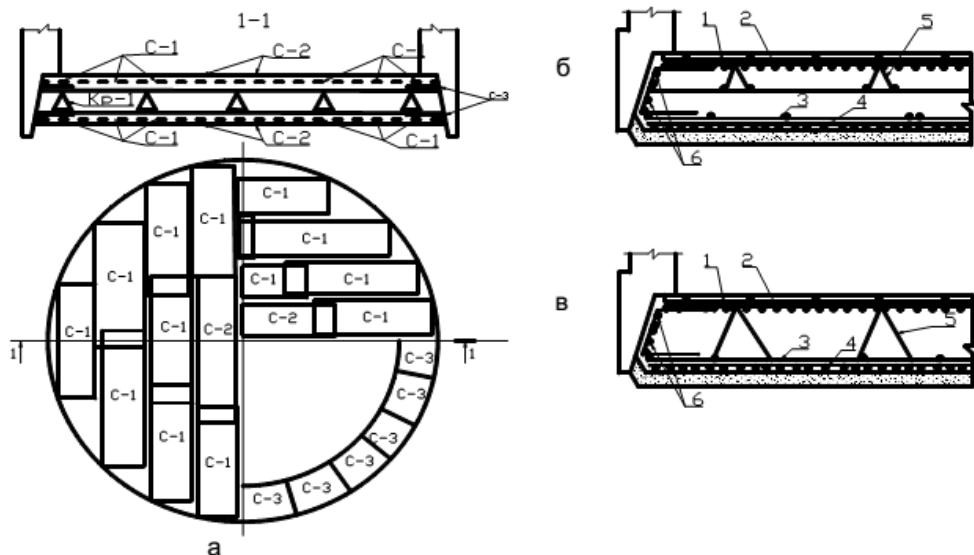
Схеми армування днища: а – з укладанням по контуру днища плоских сіток; С-1, С-2, С-3 – типи сіток і порядок їх укладання; К-1 – каркаси; б, в – з розташуванням по контуру гнутих сіток; 1, 2 – сітки верхніх арматур; 3, 4 – сітки нижніх арматур; 5 – каркаси; 6 – гнуті сітки (запозичено з [11]).
